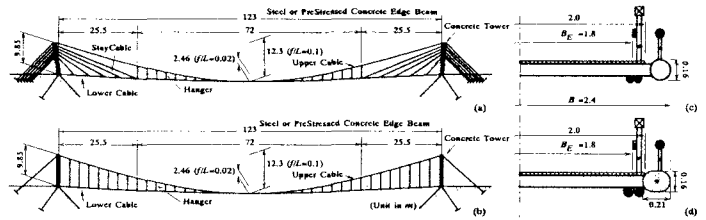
吊床版斜張吊橋および吊床版吊橋の側面図と主桁断面図
